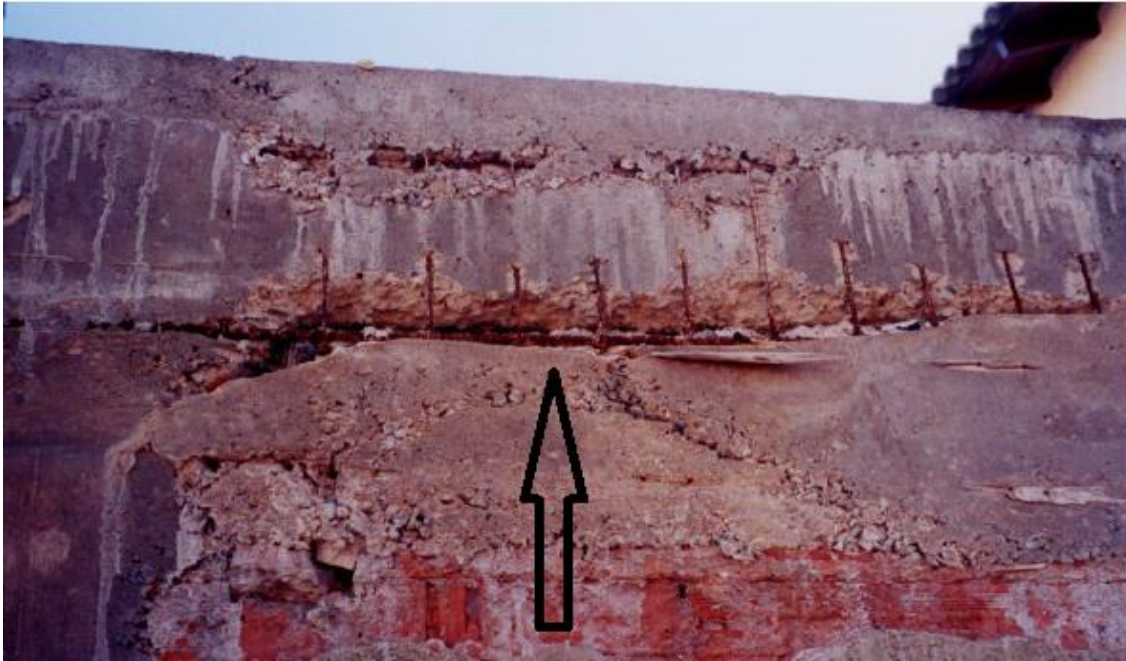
Deslocamento da armadura da viga. Fonte: autores.
